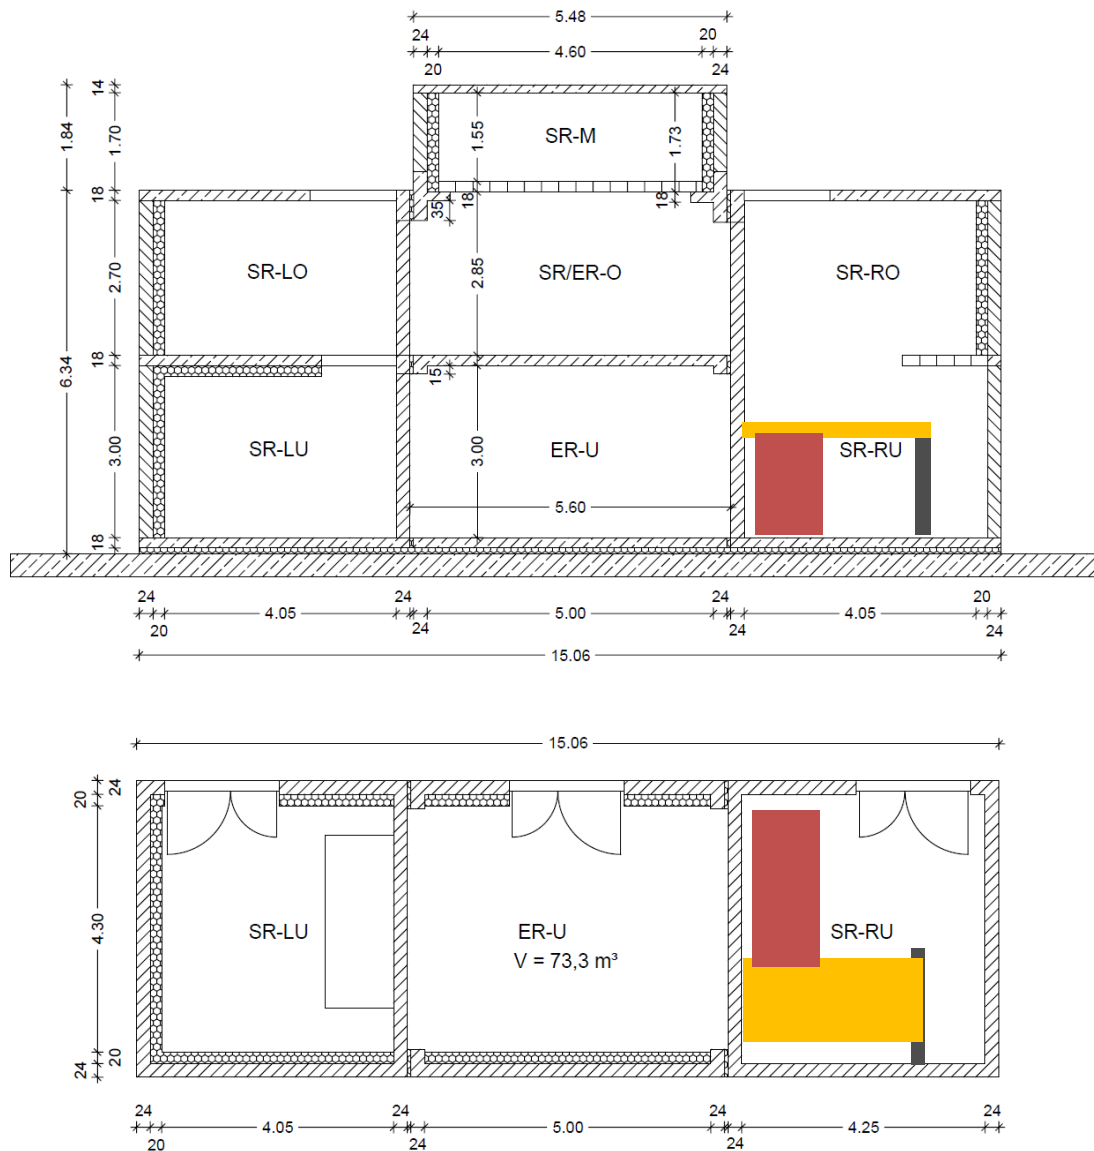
Grundriss und Schnitt des Treppenprüfstandes mit Skizzierung der Prüfaufbauten (nicht maßstäblich) mit Referenztreppenpodest (gelb), Referenztreppenlauf (rot) und Hilfswand (grau). Der Raum mit der Bezeichnung ER-U ist der Empfangsraum für die horizontale Trittschallübertragung
